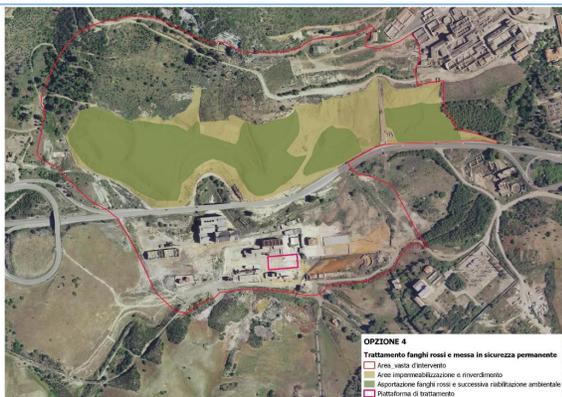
Planimetria degli interventi dell'opzione progettuale n. 4
